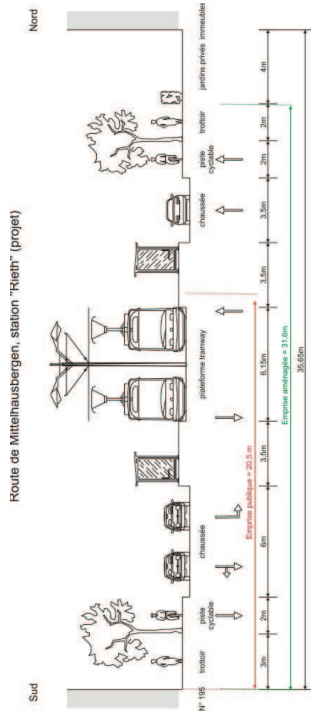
Situation projetée. Coupe d'insertion sur la rue de Mittelhausbergen (variante 3)
